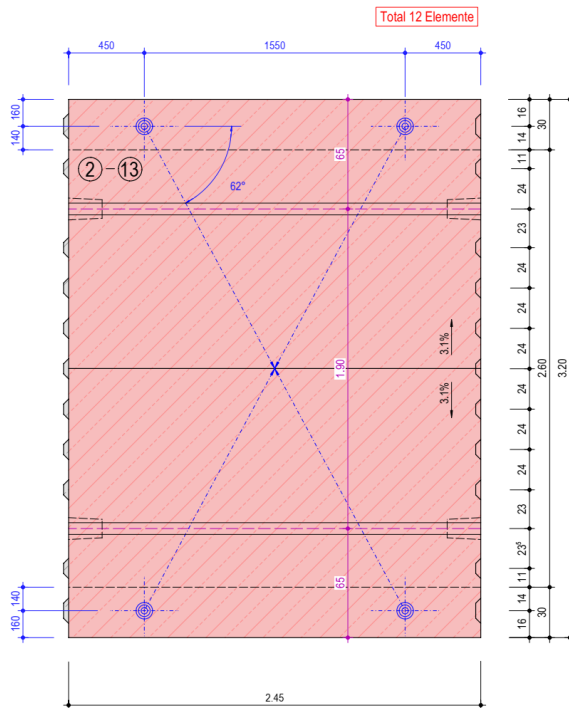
Grundriss Normalelement Nr. 2-13
